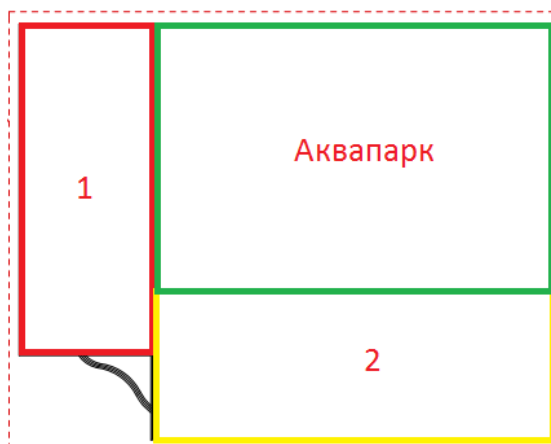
Схема розташування блоків і корпусу аквапарку.
